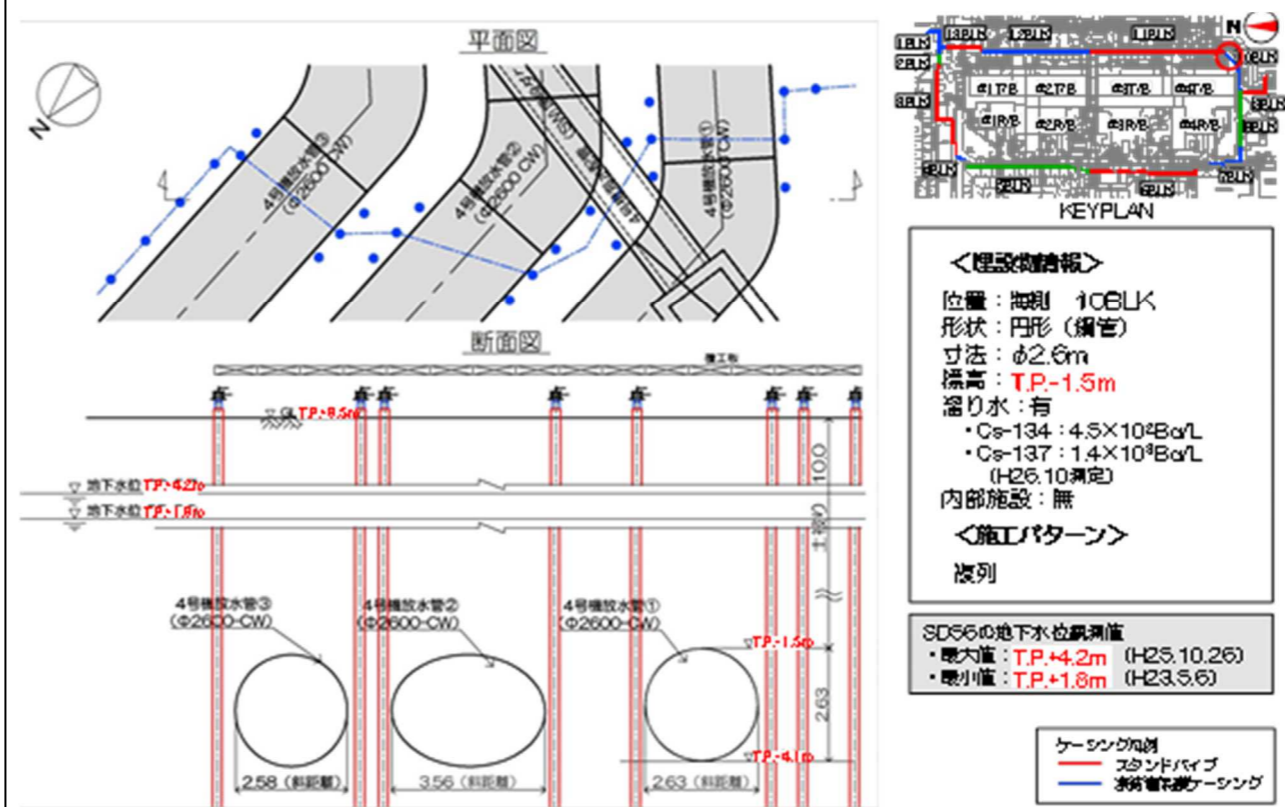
【10-3】4号機放水管①②③ 施工方法 (複列施工)
